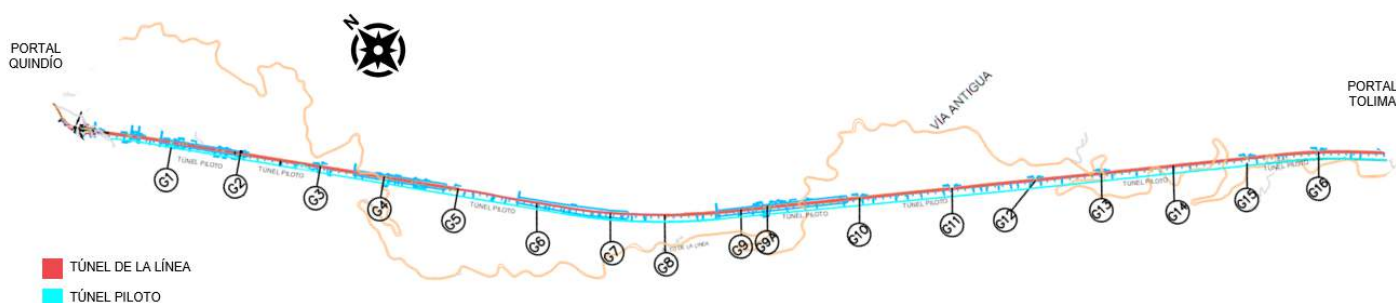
Planta Túnel de la Línea, Túnel Piloto y galerías.
